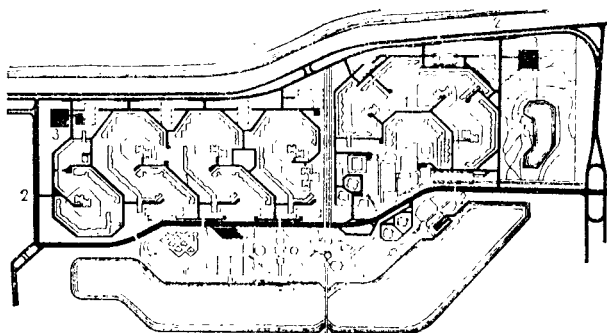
Схема размещения проездов и гаражей на территории экспериментального жилого комплекса
